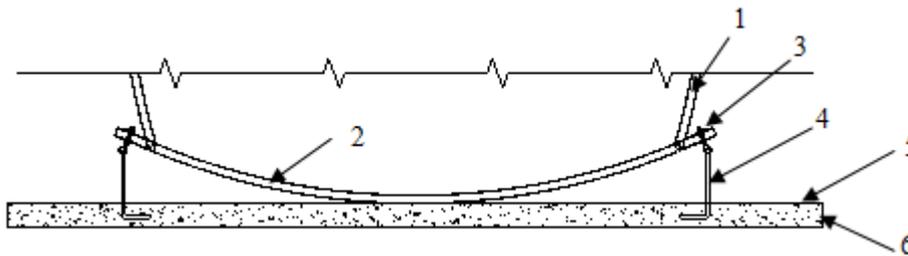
钢结构管廊混凝土垫层的外延作为外挑的抗浮示意
